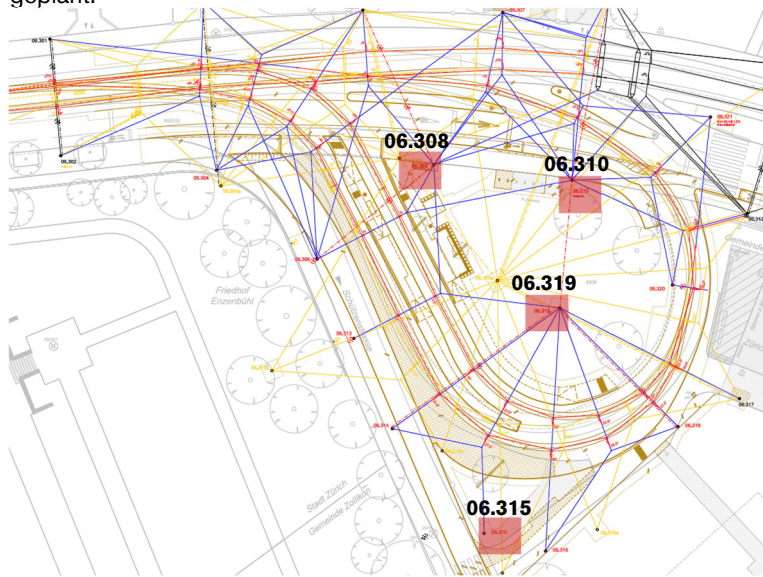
Situationsplan VBZ Wendeschleife Rehalp, Erweiterung & Instandsetzung Tramhaltestelle, VBZ vom 31.07.2024. Rot markiert sind die mit der vorliegenden Baugrunduntersuchung untersuchten Masten.
